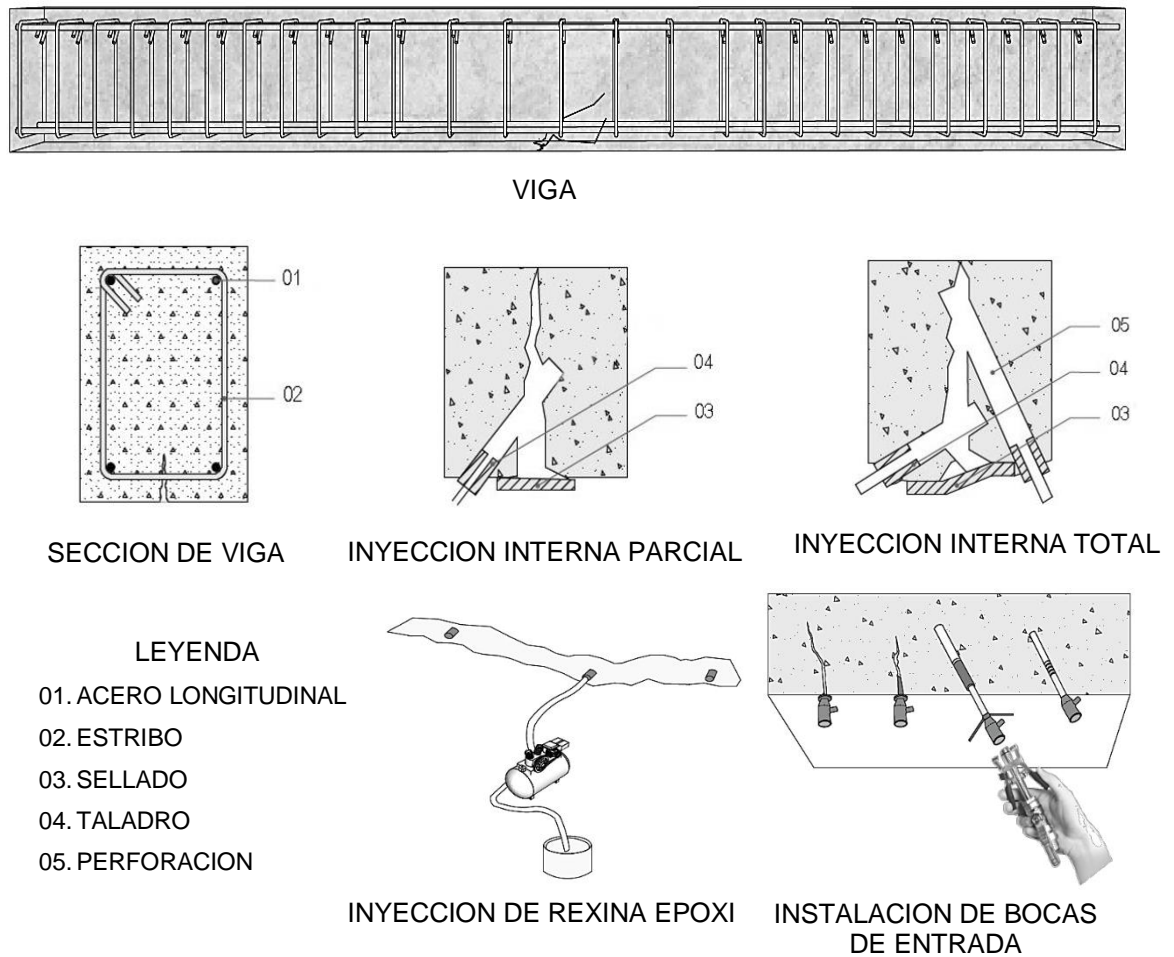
Procedimiento de reparación de fisuras y grietas mediante inyección de resina epoxi
